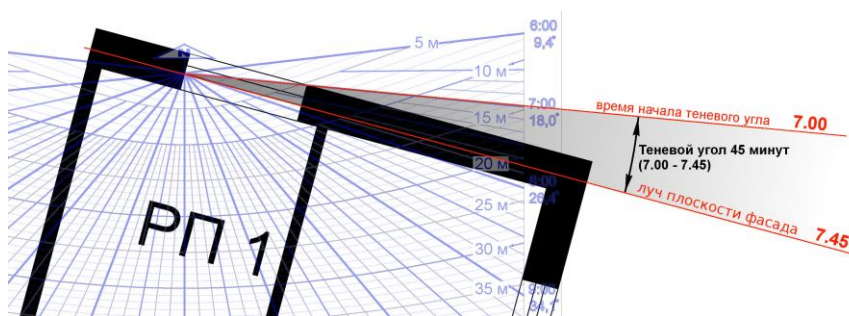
Схема совмещения ИЛ и плана квартиры для определения времени начала теневого угла (схема плана)
